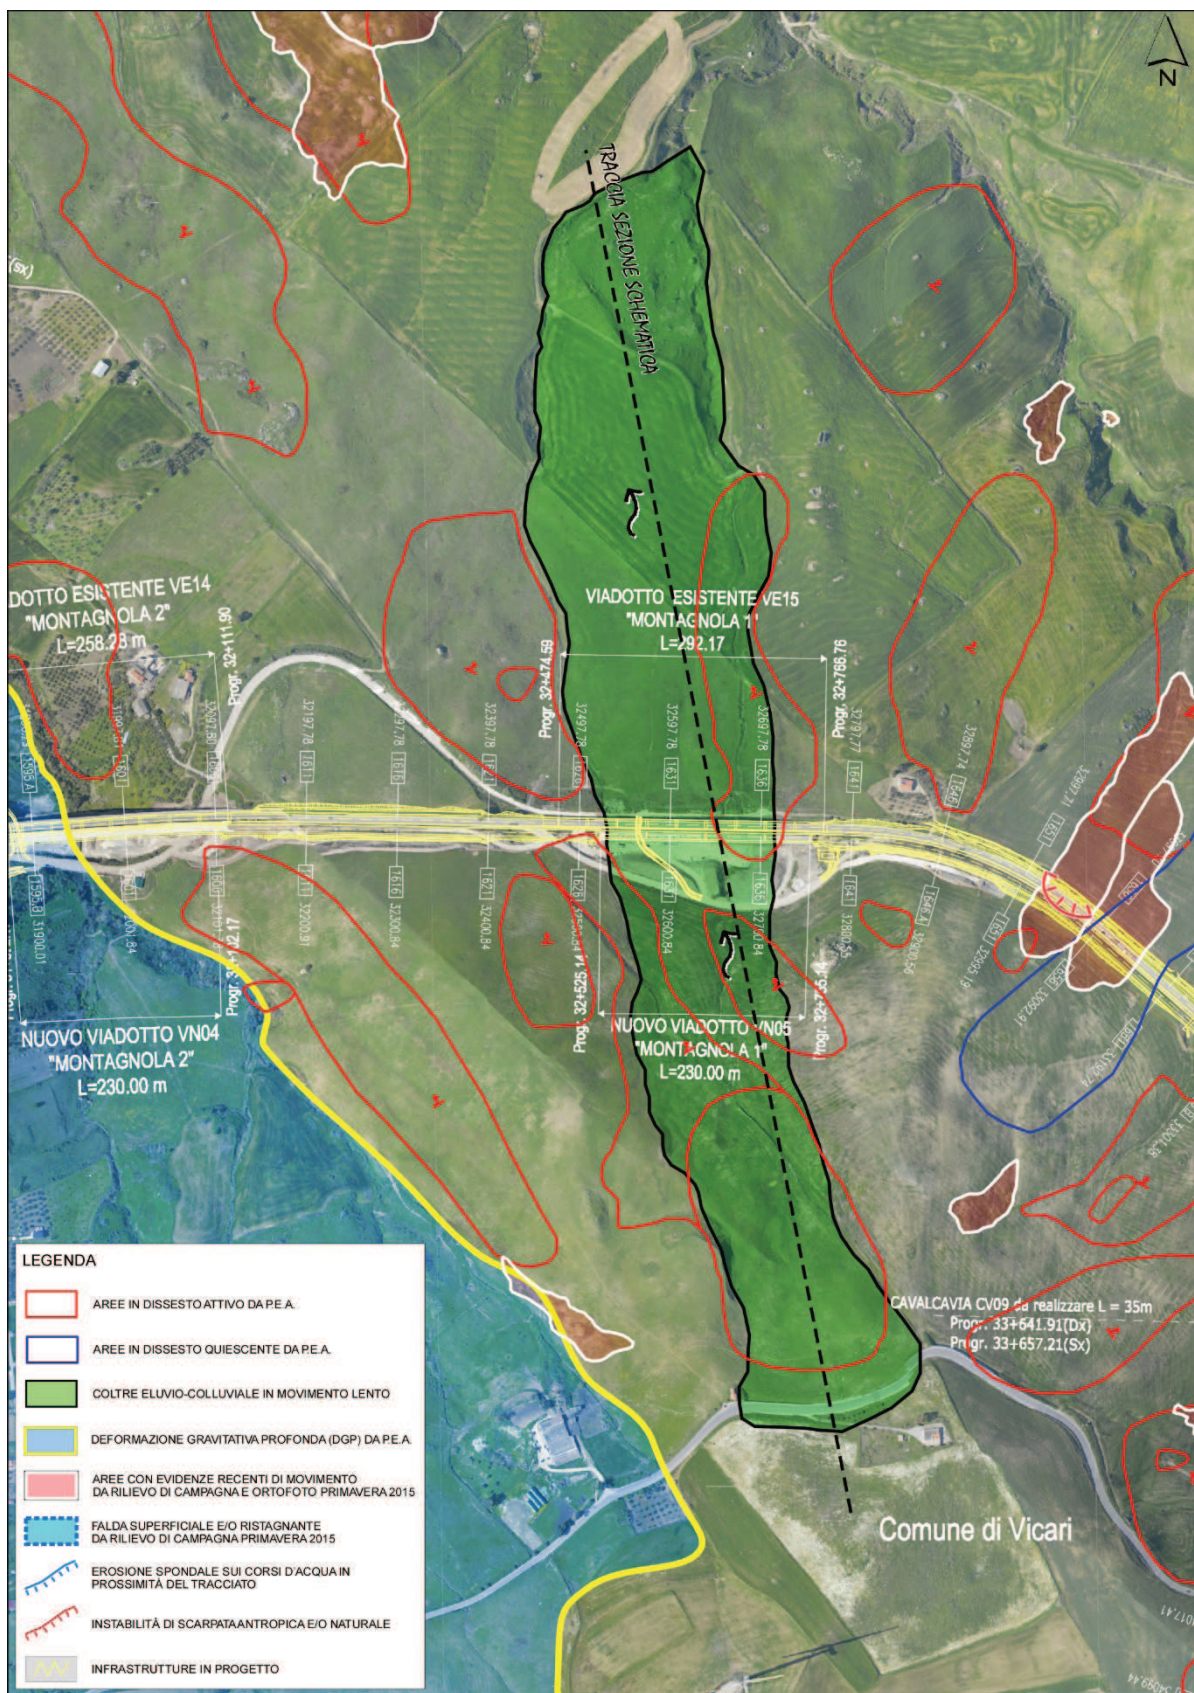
PK 32+474, VIADOTTO ESISTENTE VE15 – MONTAGNOLA 1 E NUOVO VIADOTTO VN05. Individuazione planimetria dell'area in movimento
